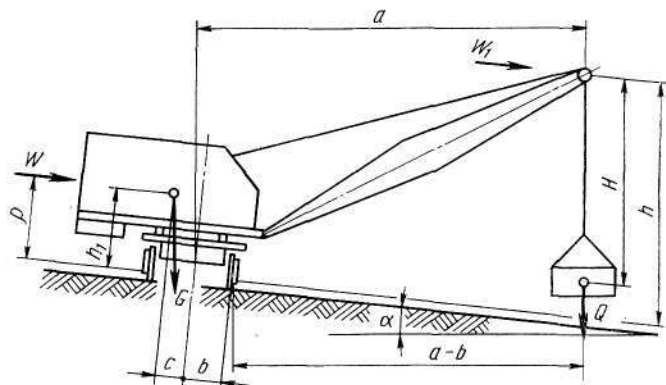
К расчету коэффициента грузовой устойчивости крана
